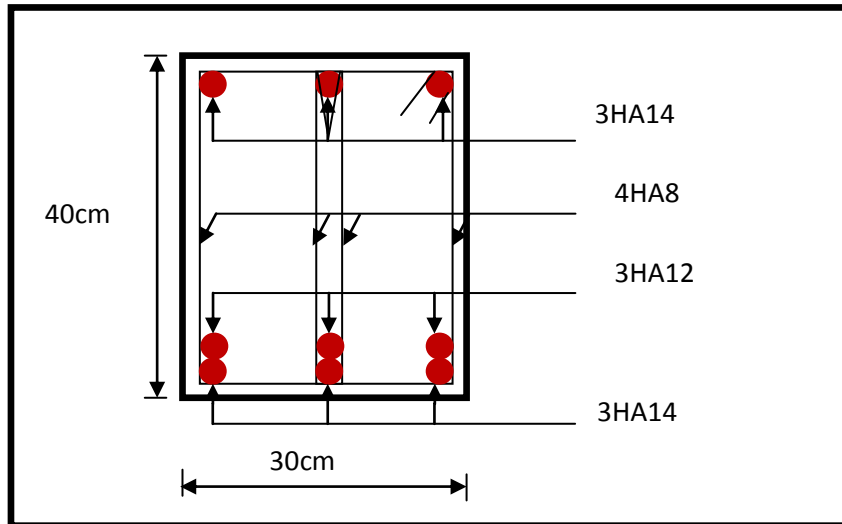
Ferrailage en travée d'une poutre principale.
